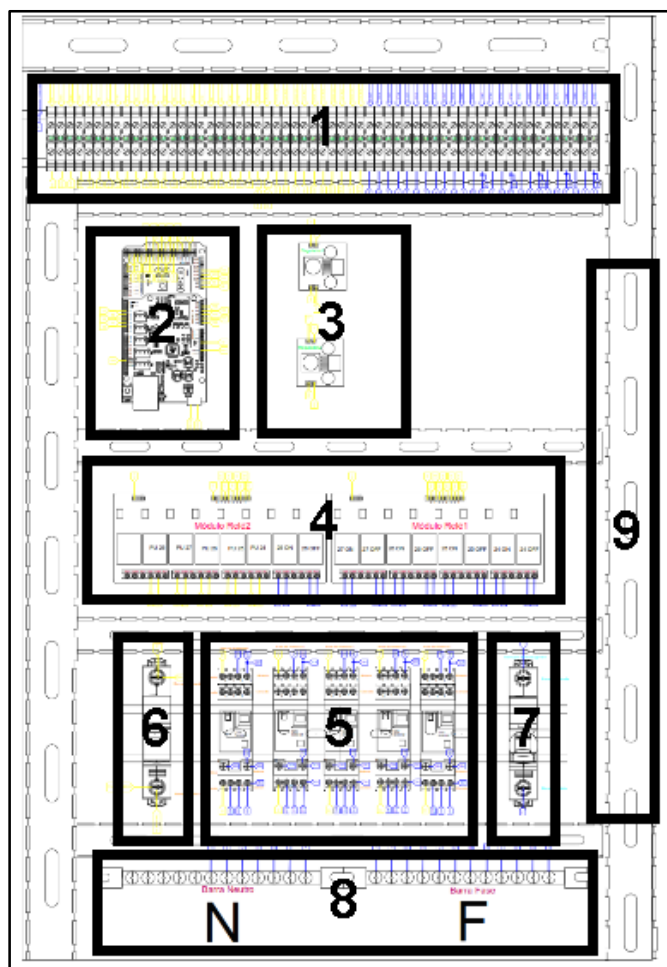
Vista frontal del tablero en AUTOCAD.
